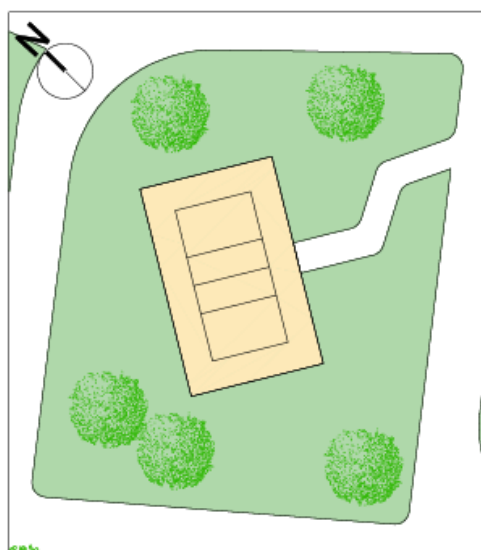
Planta de Pormenor do Campo de Voleibol Praia.
